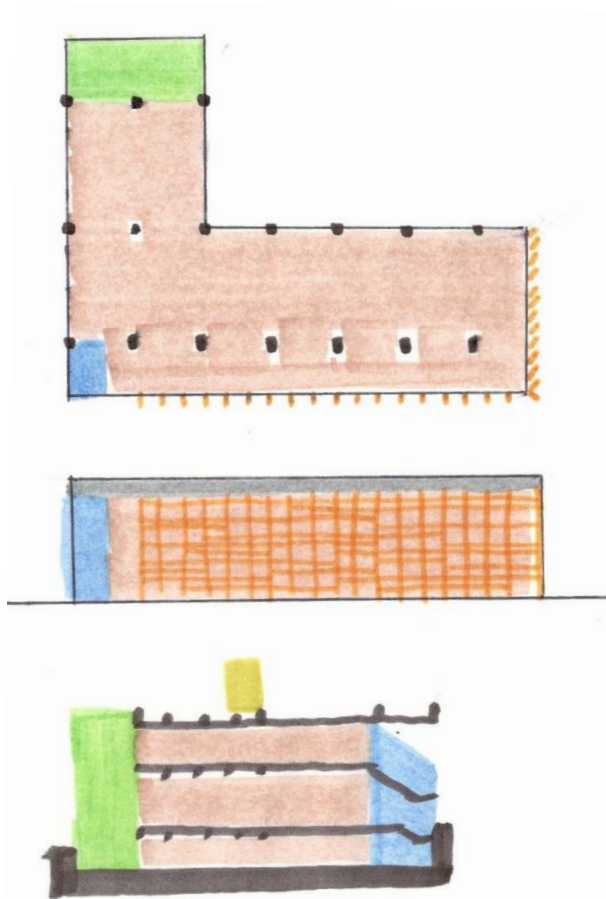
Unibanco. Os brises se destacam na fachada juntamente à circulação vertical, todos originalmente em concreto aparente.
